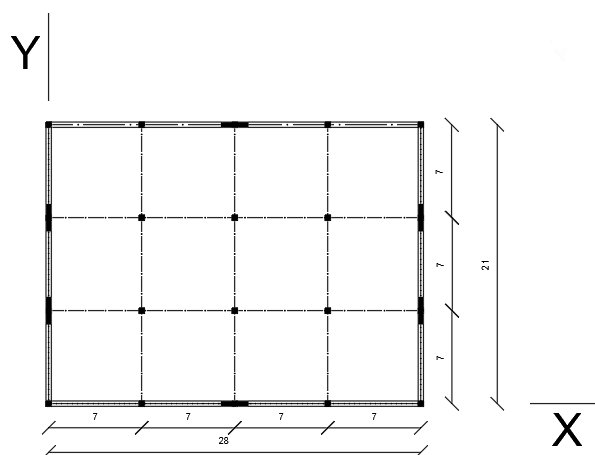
Disposição em planta tipo dos elementos estruturais para os edifícios com paredes de contraventamento
